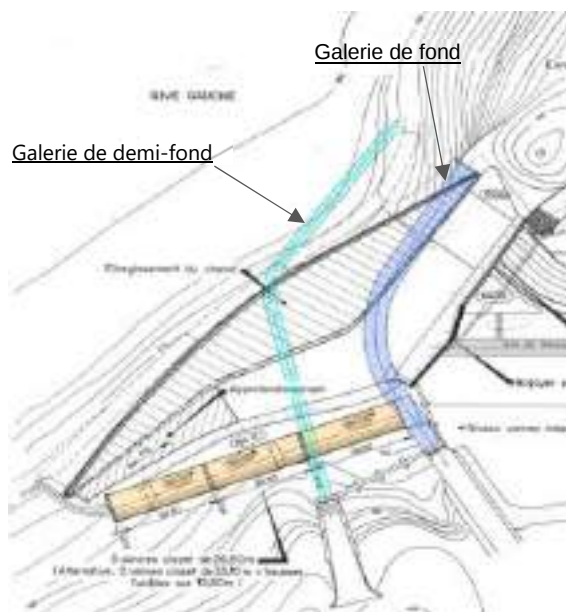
Vue en plan des implantations des galeries de fond et demi-fond
